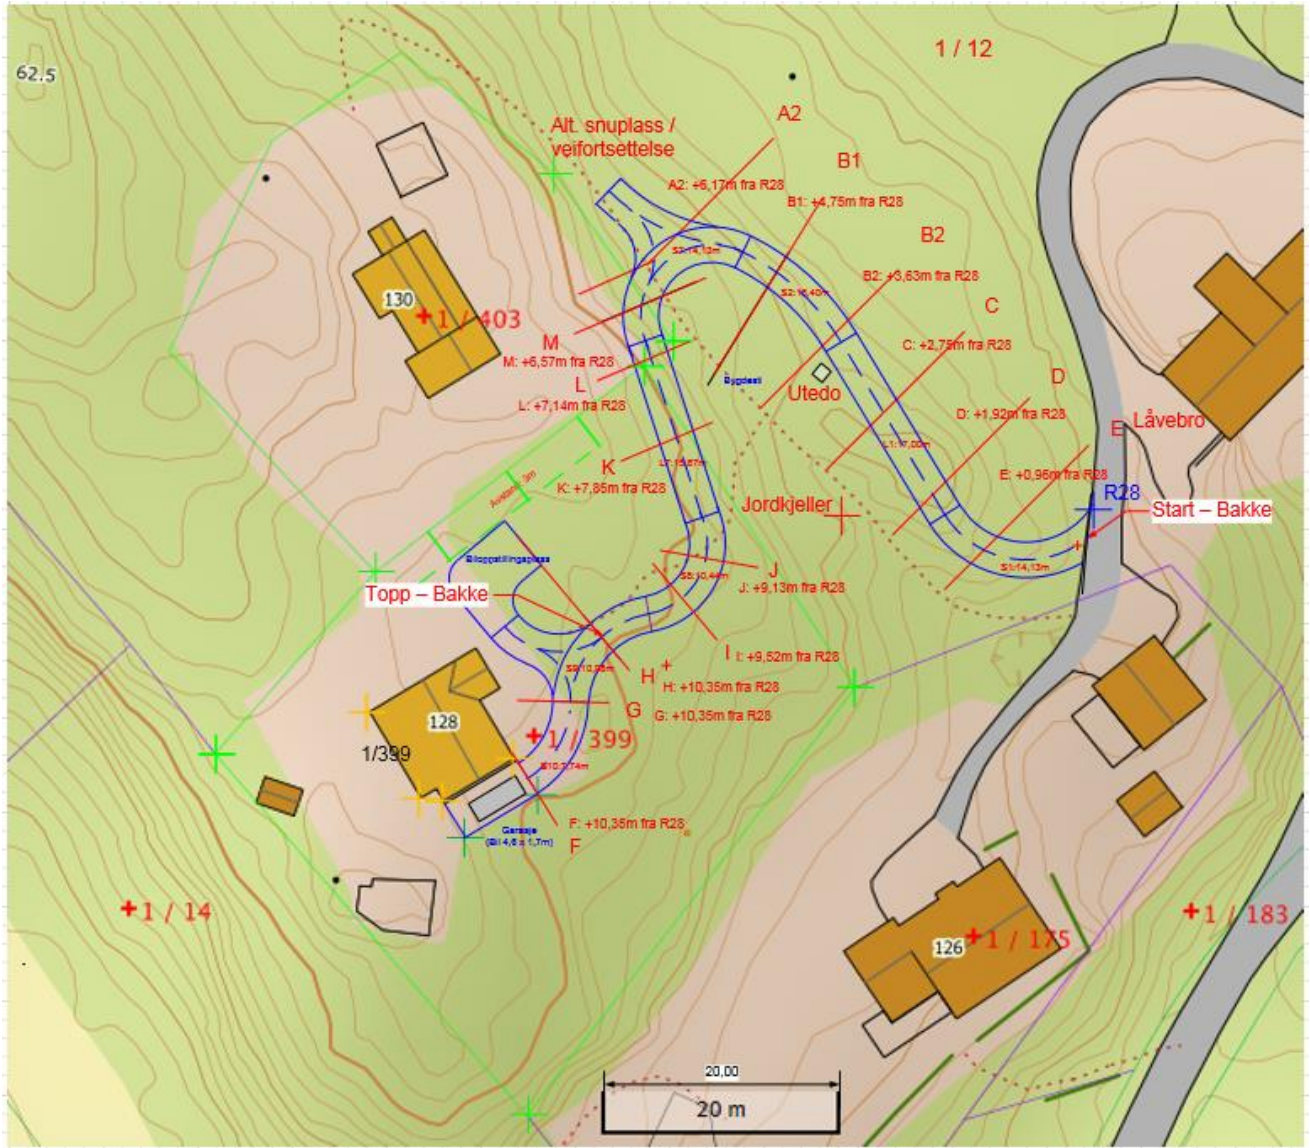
Privat tilkomstvei til GBNR1/399 - trase vist i Plan
